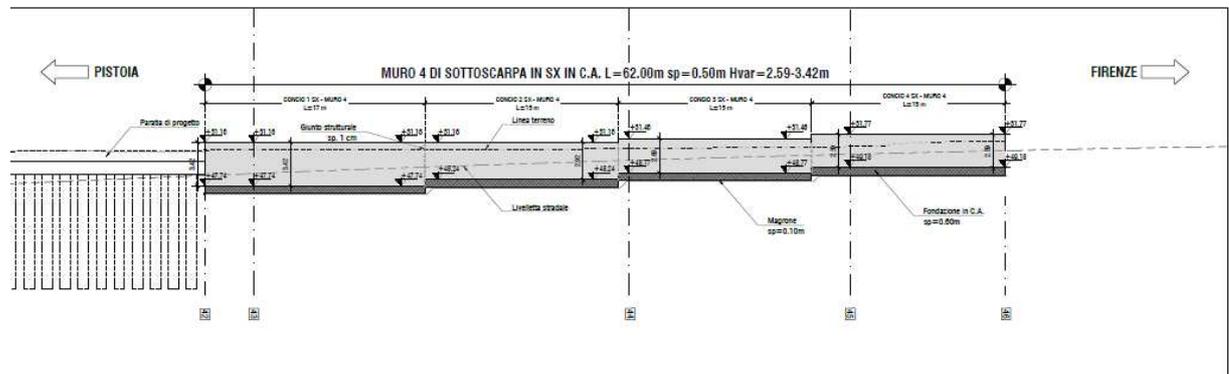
Stralcio planimetrico e prospetto muri di sottoscarpa 4 asse Sx in direzione Firenze
